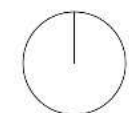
Planta de espelho d'água leste. / elaborado pelo autor.
